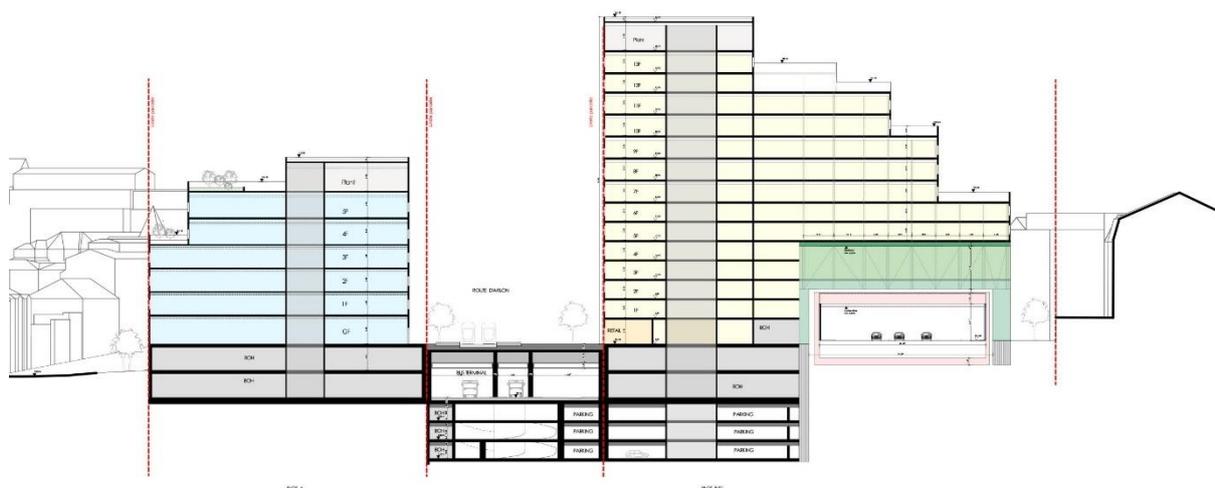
Coupe de principe des constructions projetées dans leur environnement urbain, sur les lots A et BC
